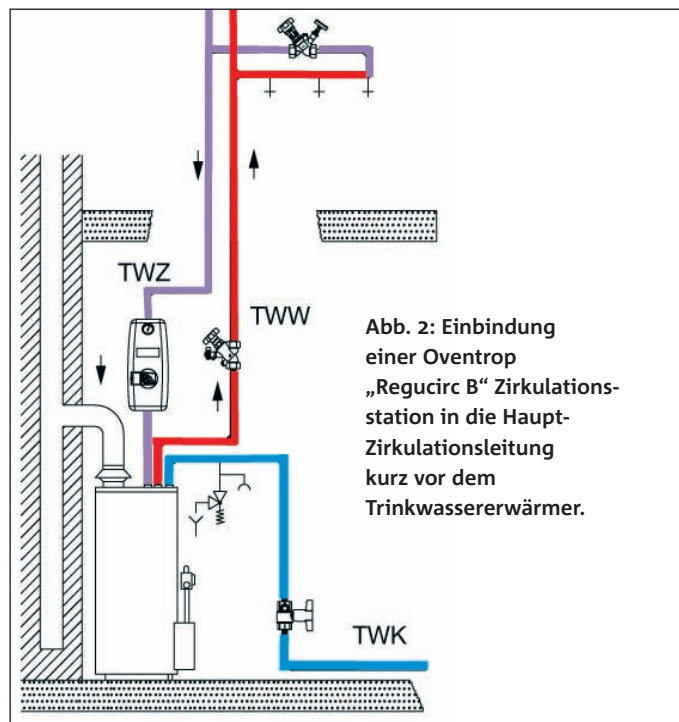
Einbindung einer Oventrop „Regucirc B“ Zirkulationsstation in die Haupt-Zirkulationsleitung kurz vor dem Trinkwassererwärmer.
